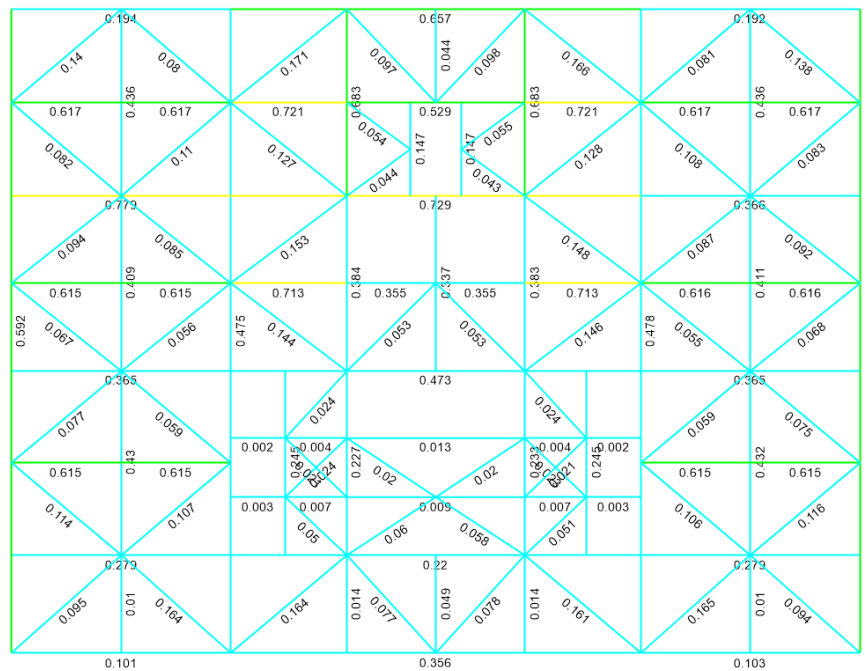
Factores de utilización planta primer nivel para cargas de diseño LRFD.
